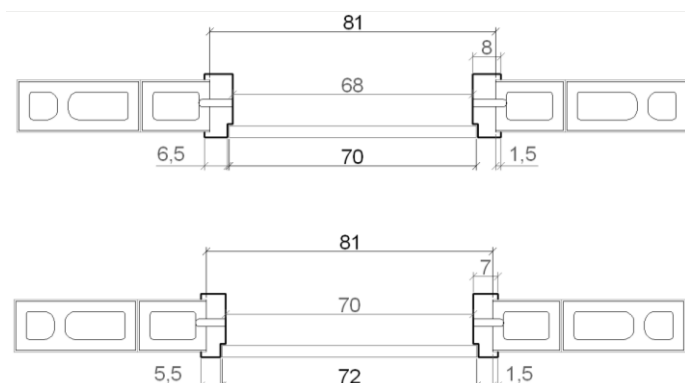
Batente metálico envolvente adaptado a folhas de porta de madeira de 70 e 72 cm de largura em vão de porta de 81 cm (medidas em centímetros)
